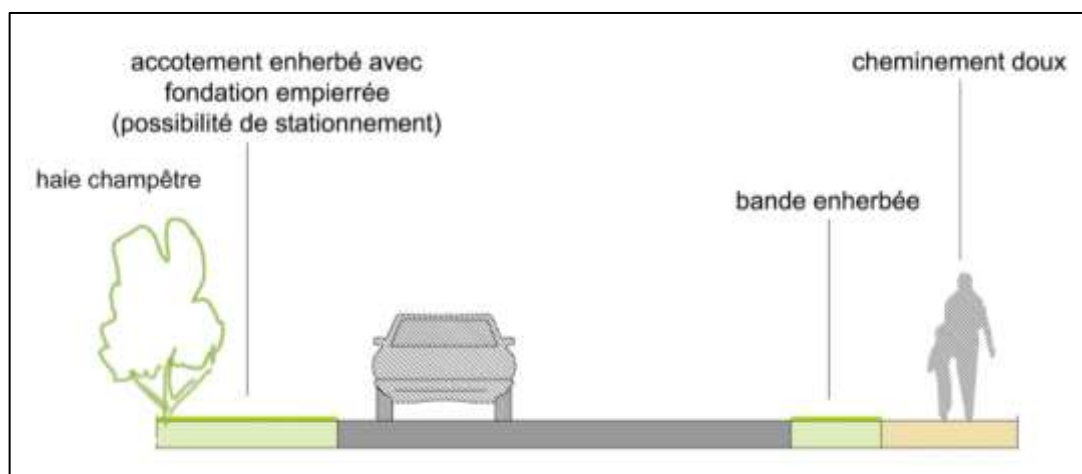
Exemple de profil en travers envisageable pour la voie à créer
